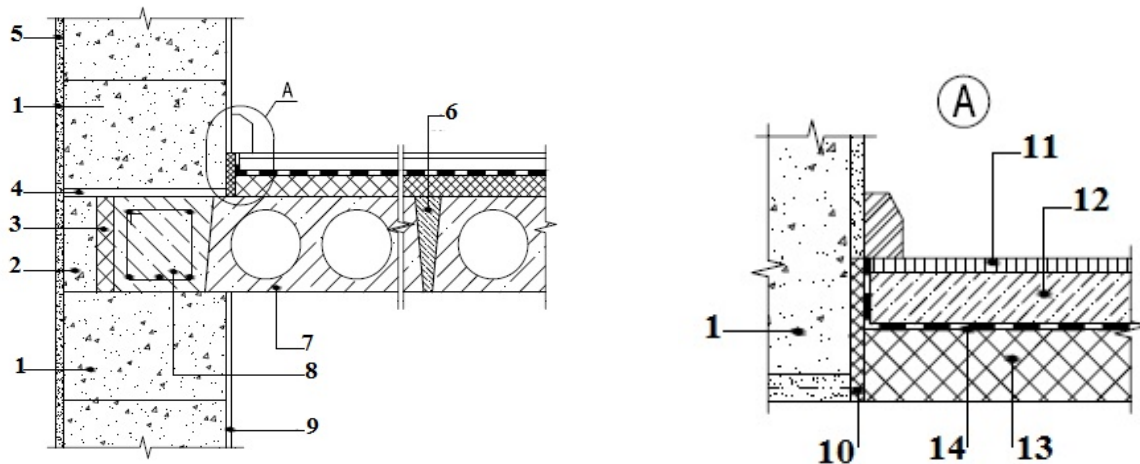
Узел примыкания железобетонных плит перекрытий к наружной стене из газобетонных блоков: 1 — блок YTONG; 2 — доборный блок; 3 — минераловатная плита; 4 — шов из цементного раствора; 5 — наружная отделка; 6 — арматура для анкерки плиты в венце; 7 — сборные железобетонные плиты; 8 — монолитный железобетон; 9 — внутренняя отделка; 10 — пенополистирол; 11 — покрытие пола; 12 — цементная стяжка; 13 — утеплитель; 14 — гидроизоляция
